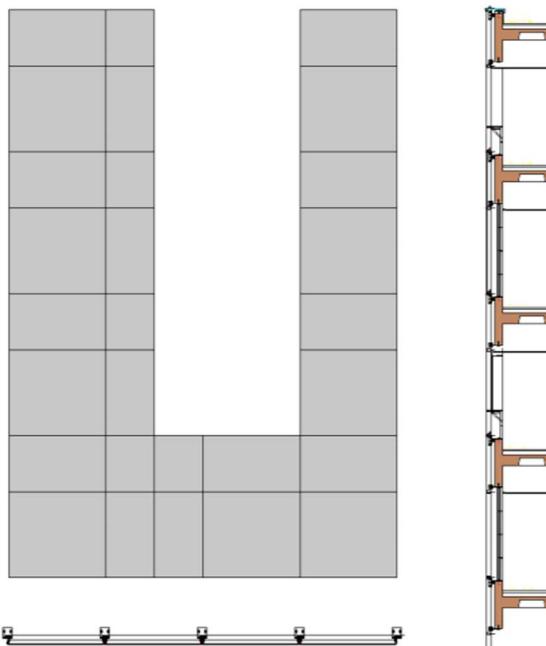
Modelagem da fachada após a retirada dos painéis. Fonte: Relatório Petrucci Consultoria e Engenharia. Plano de desmontagem da fachada cortina (21/12/2017).
